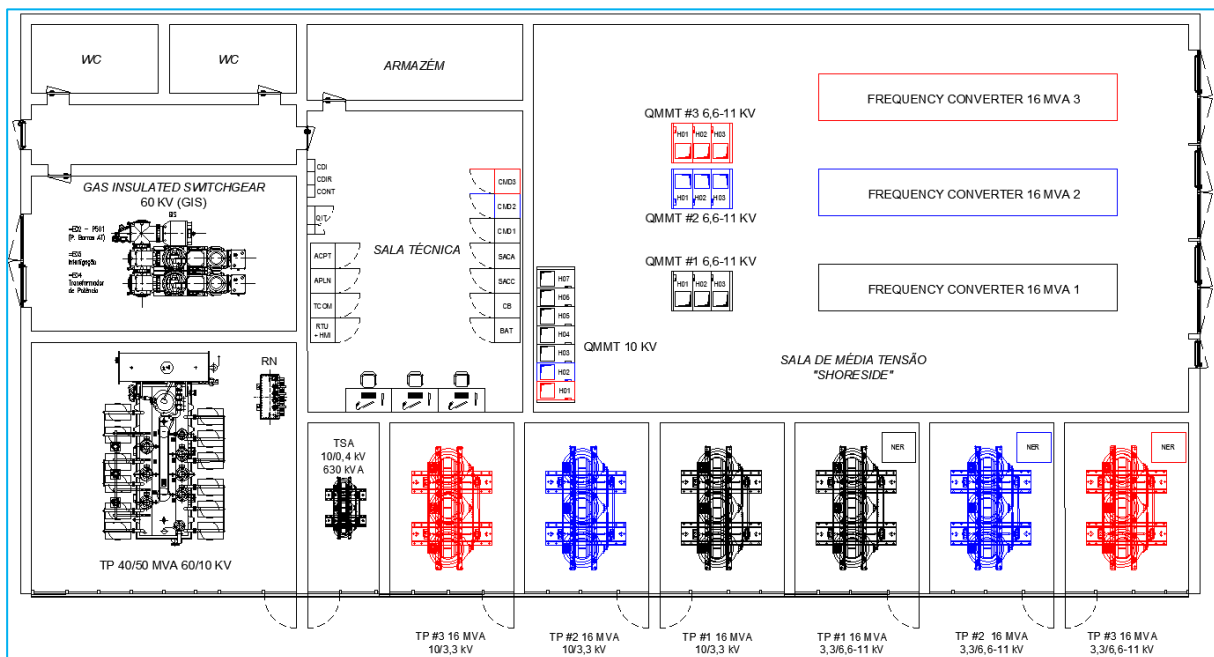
Disposição em planta dos equipamentos da Subestação Principal
